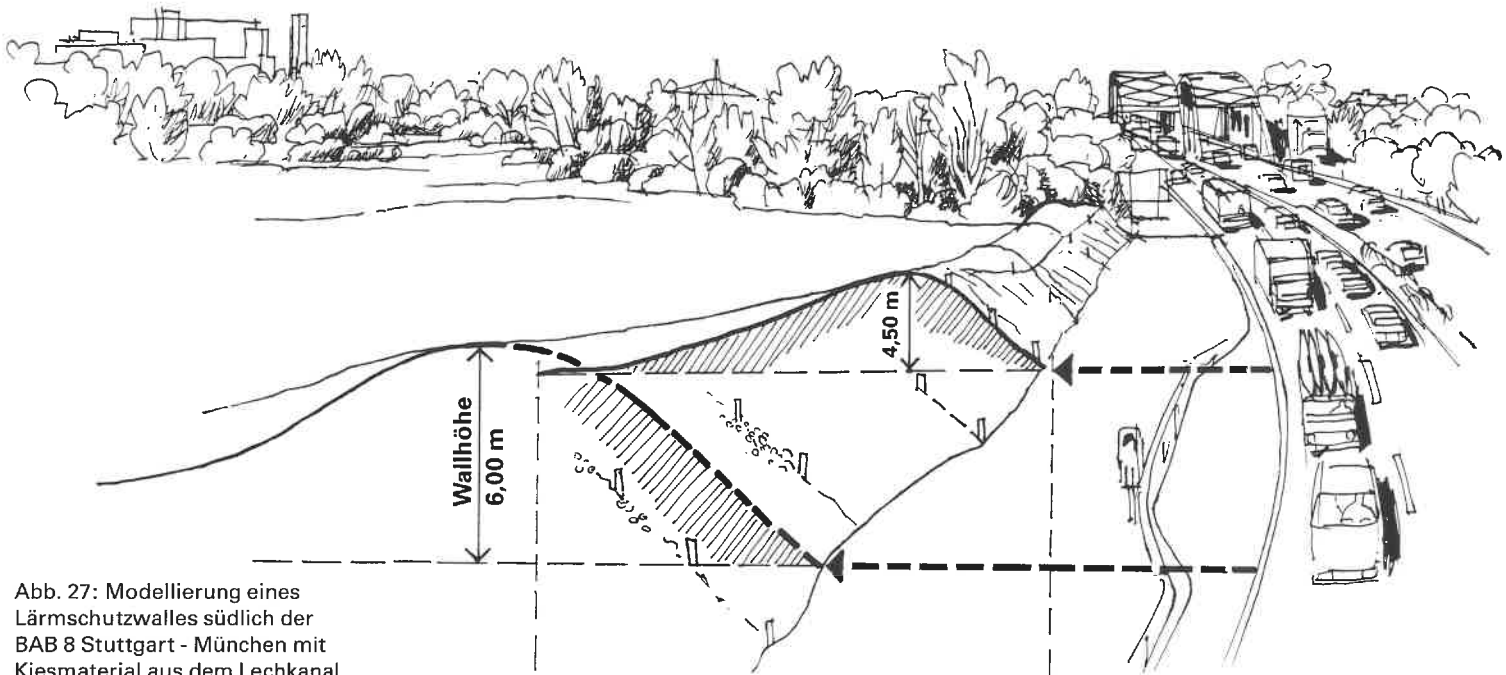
Modellierung eines Lärmschutzwalles südlich der BAB 8 Stuttgart - München mit Kiesmaterial aus dem Lechkanal bei Gersthofen.
